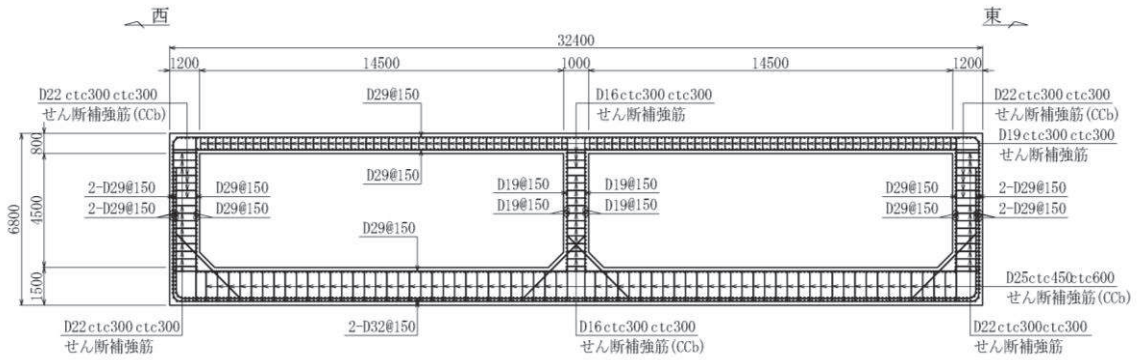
軽油タンク室概略配筋図 (B-B 断面, 東西 (タンク室))
